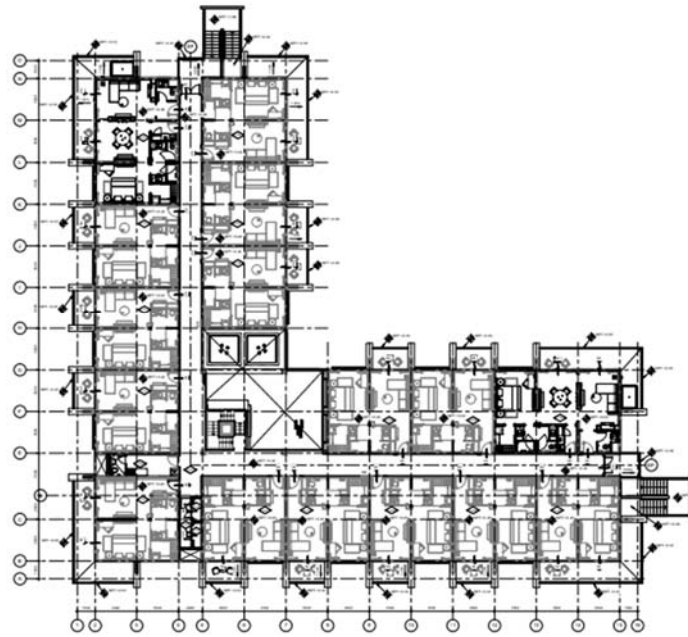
Edificio 01 - Planta arquitectónica nivel +3,40 m
